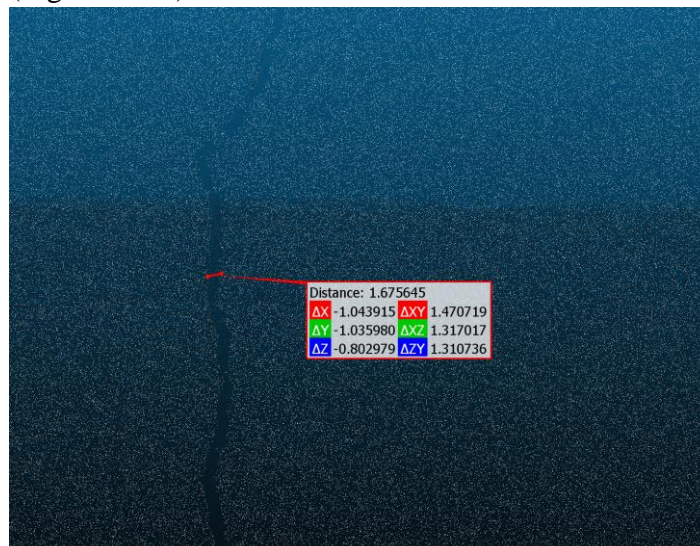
53 : Fissure principale de la poutre armature continue à 25 mm de flèche
